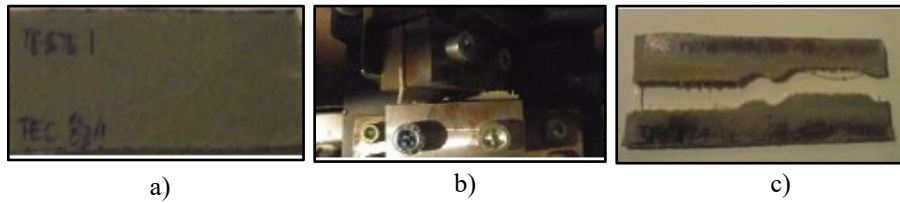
Torção tela Cimentícia s/ pré-corte: a) antes do ensaio, b) em ensaio, c) após o ensaio
